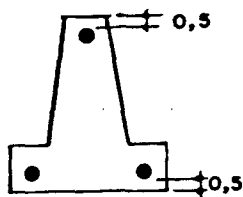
POSIÇÃO DA ARMADURA (COBRIMENTO = 0,5 cm)
